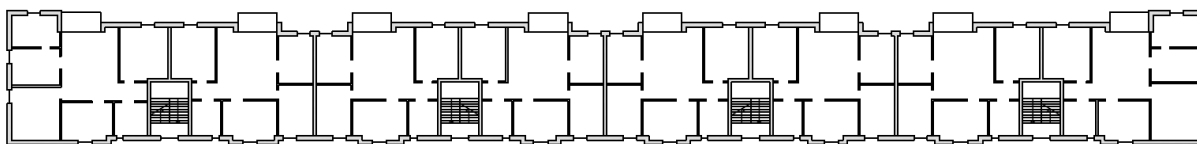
Sección planta tipo [Anexo II. Planos]
